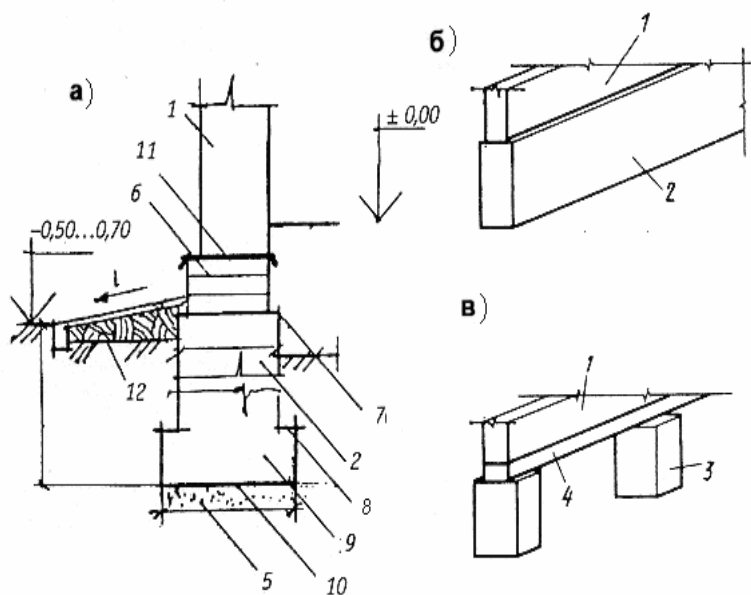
Схемы фундаментов: а – общий вид; б, в – конструктивные схемы фундаментов малоэтажных жилых зданий (б – ленточный фундамент; в – столбчатый); 1 – стена; 2 – лента фундамента; 3 – столб; 4 – фундаментная балка; 5 – песчаная подушка; 6 – цоколь; 7 – обрез фундамента; 8 – уступ; 9 – подушка; 10 – подошва; 11 – горизонтальная гидроизоляция; 12 – отмостка
